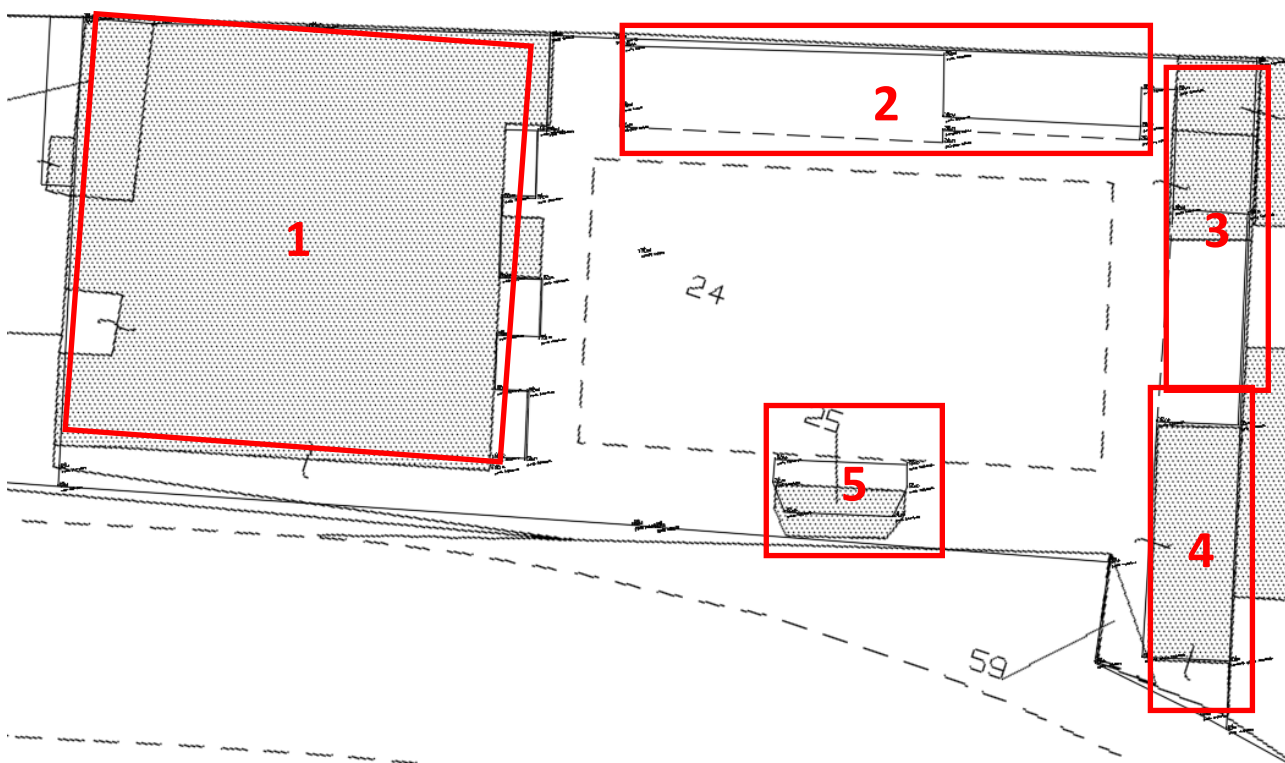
Pianta dell'area oggetto di intervento con numerazione dei Fabbricati presenti.
